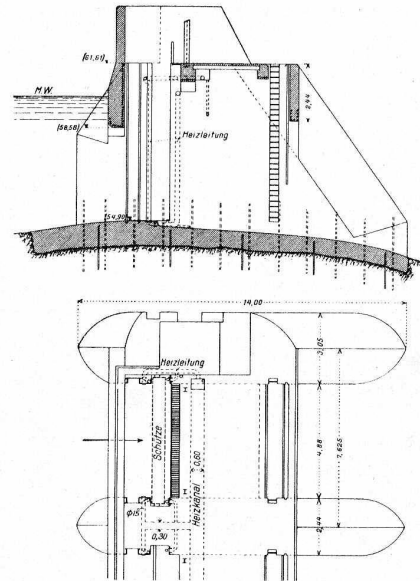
Schnitt und Grundriss einer Regulierschütze mit Heizvorrichtung für die Schützen-Nuten. — 1 : 300.
